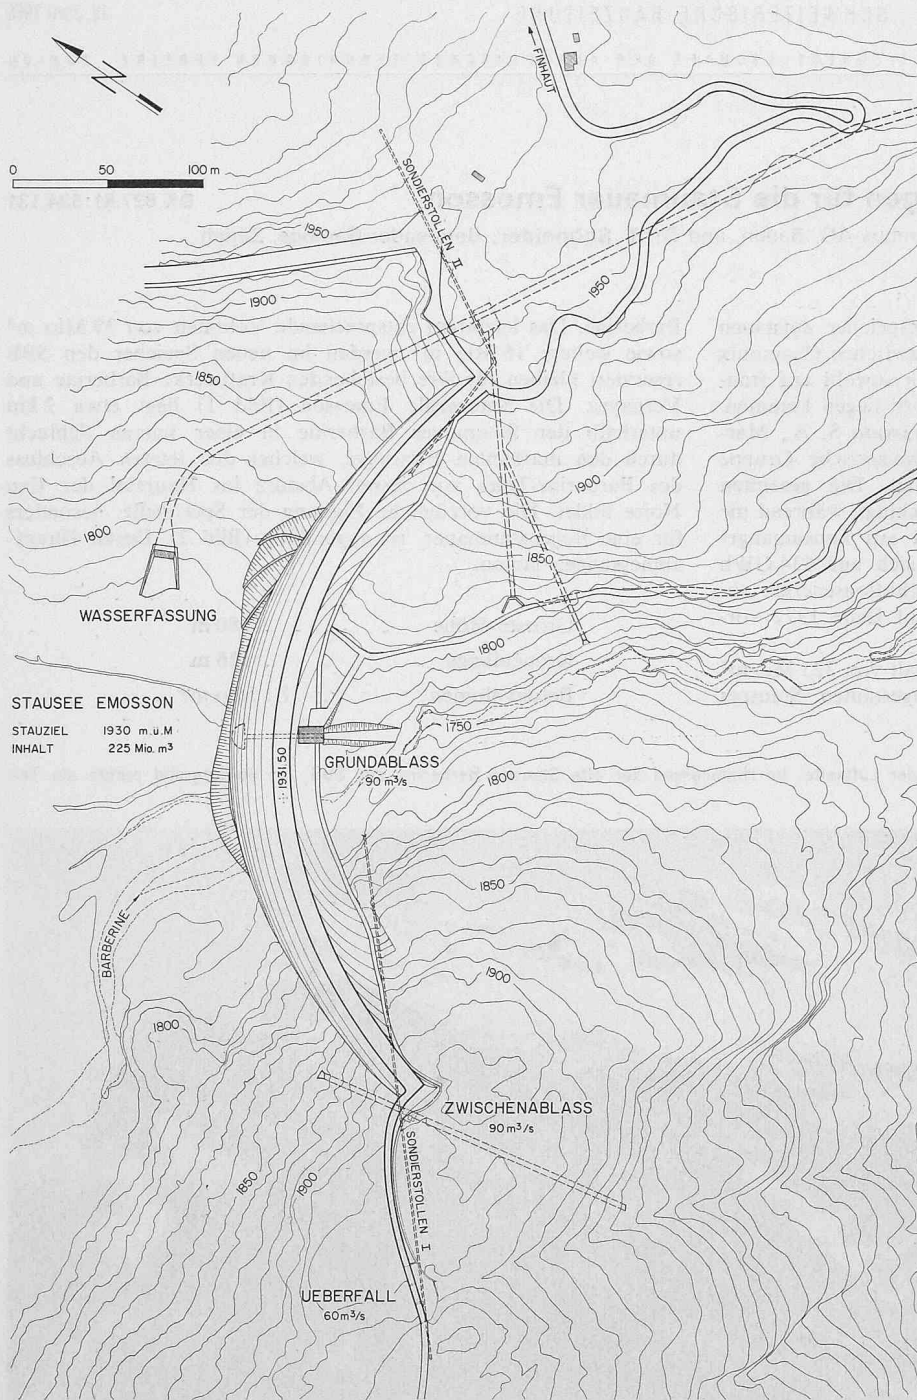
Lageplan der Bogenstaumauer, 1:4000
